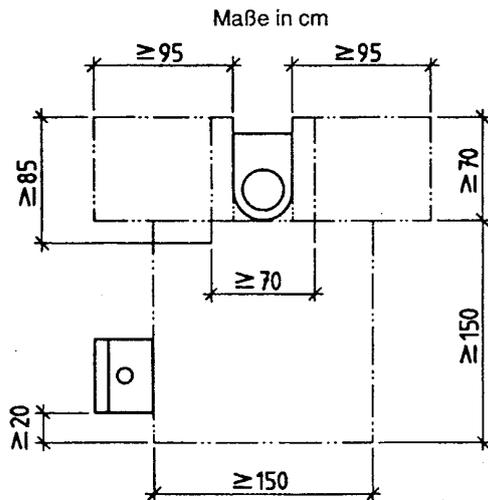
Bewegungsfläche vor und neben dem Klosettbecken, zwischen Haltegriffen und vor dem Waschtisch
